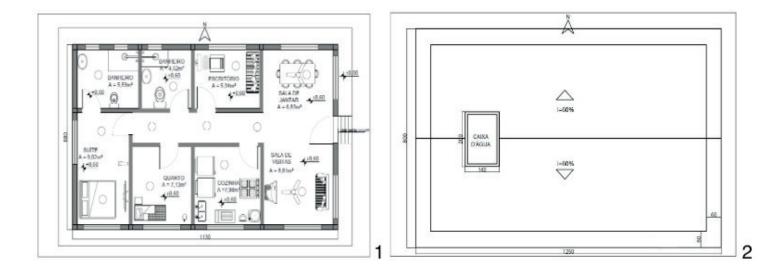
Planta baixa da edificação. Figura 2 - Planta de cobertura da edificação.
